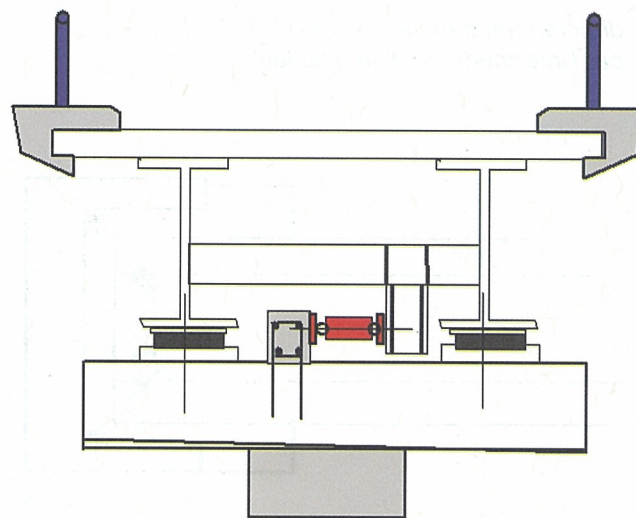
Ouvrage mixte acier-béton, mise en place avec pièce de pont et bloc d'appui inférieur
